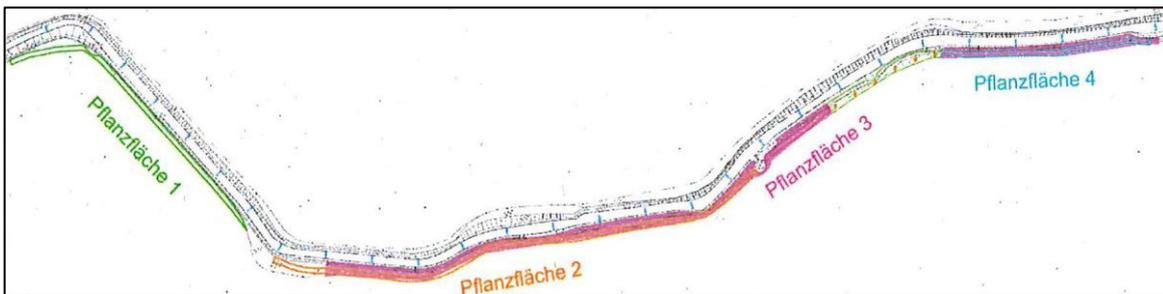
Pflanzflächen bei Station 1+800 - 3+200, Auszug aus dem Maßnahmenplan, LBP [9]
